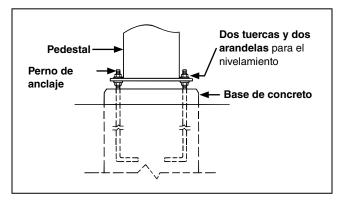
Detalle del montaje del perno de anclaje en el pedestal.
